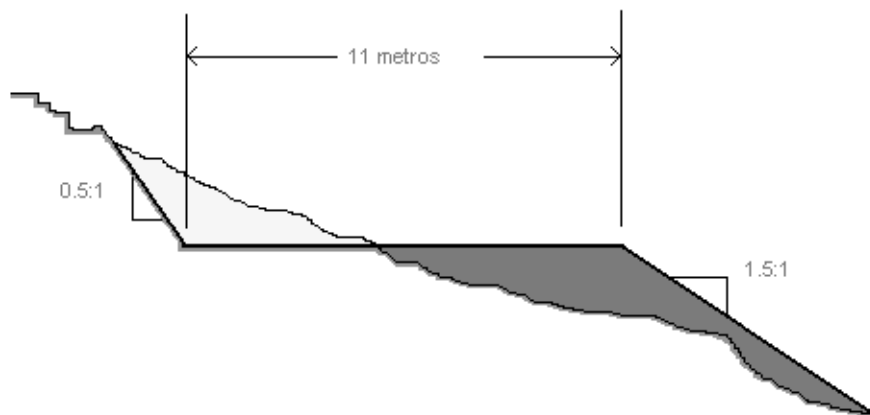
SECCIÓN TIPO PARA CORTE Y TERRAPLÉN
